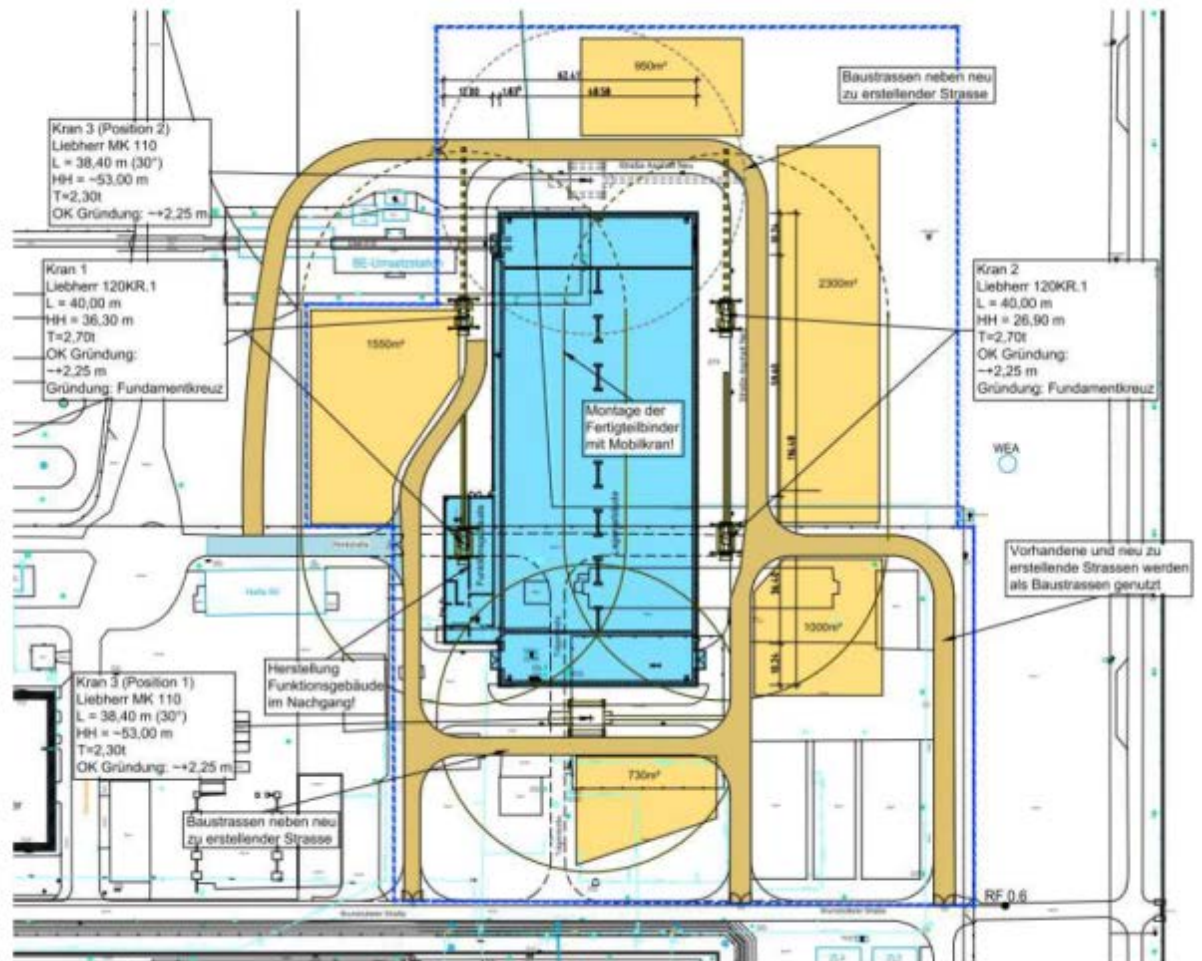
Baustelleneinrichtungsfläche
